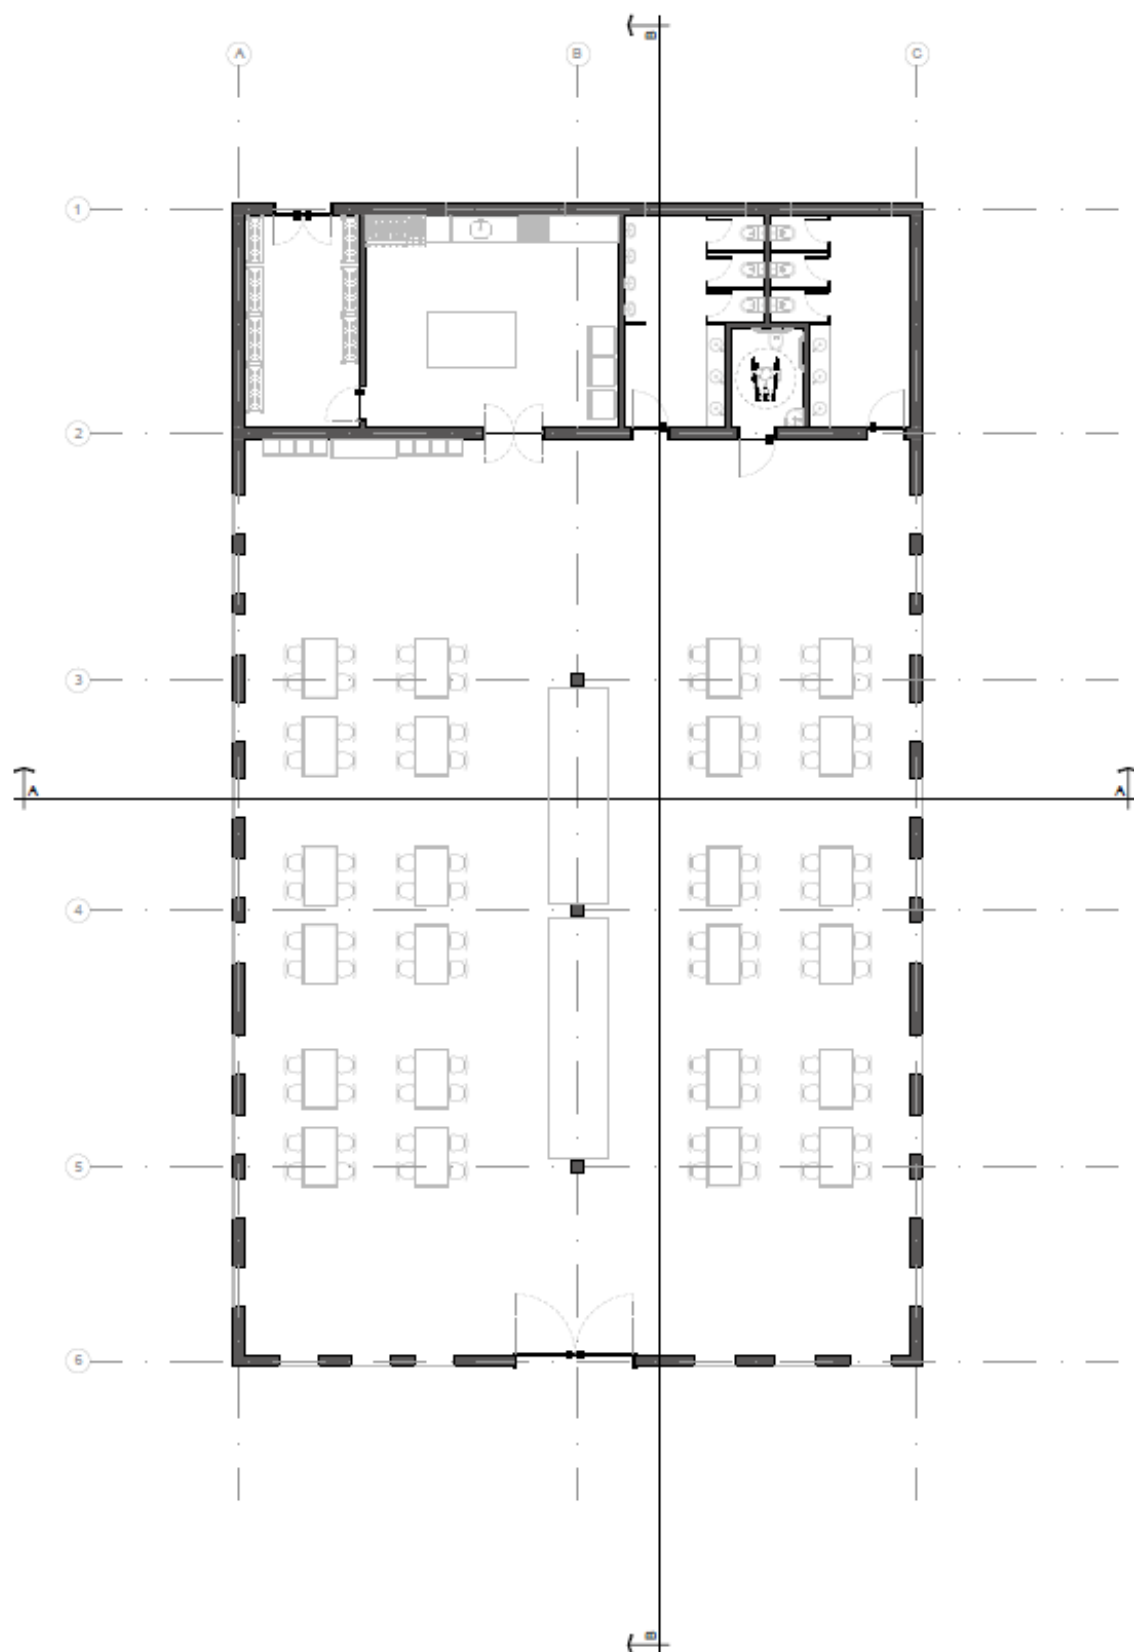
Planta baixa do equipamento 5 (Restaurante do Hotel)
